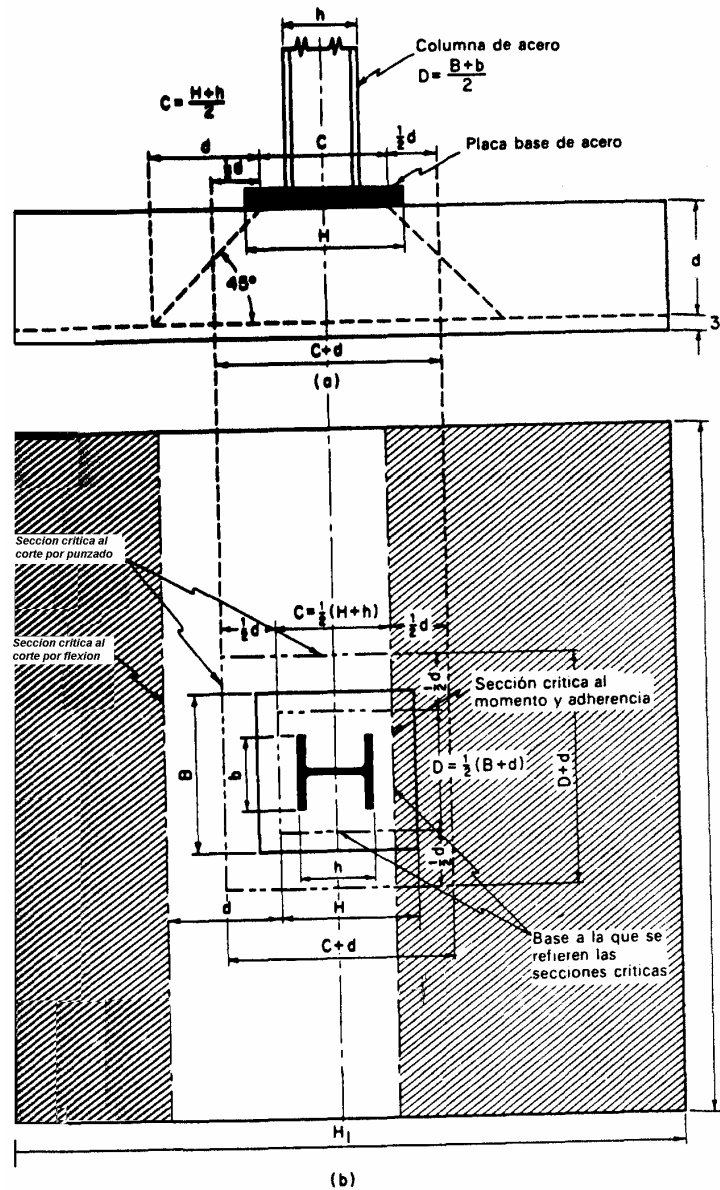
Cimentación de hormigón armado para una columna de acero.
